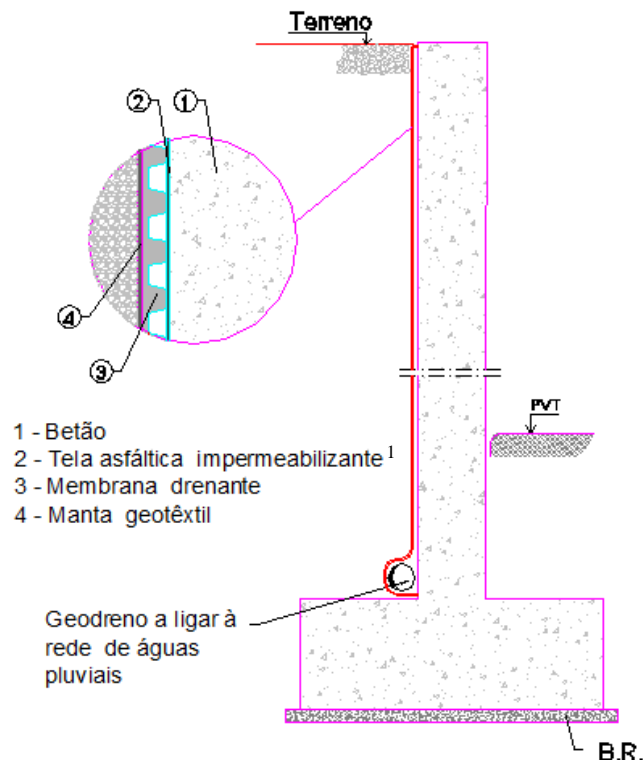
Sistema de impermeabilização e drenagem dos muros de suporte [42]
